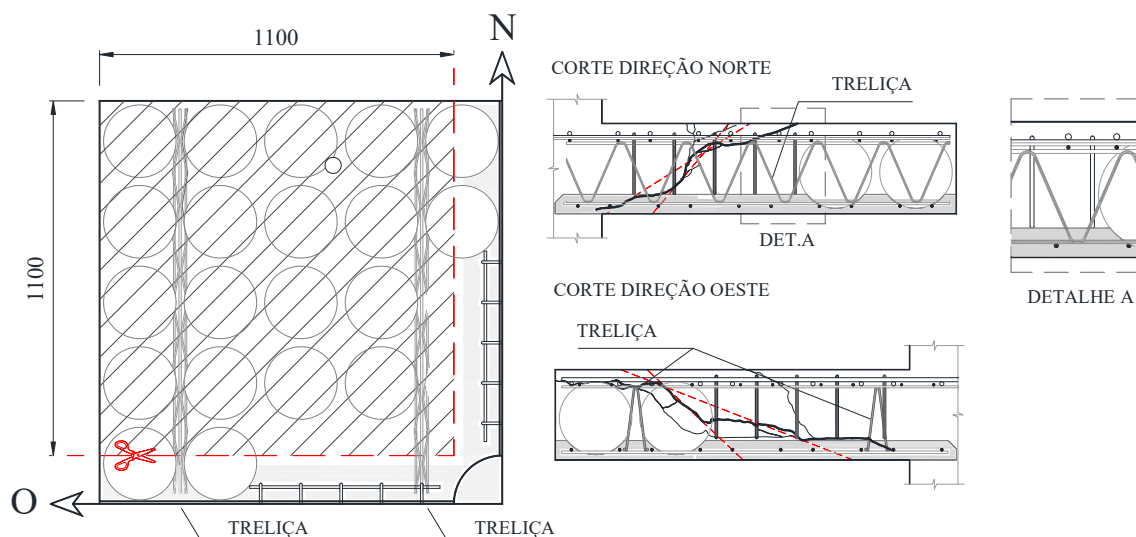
Detalhe da seção de corte da laje BD4.
